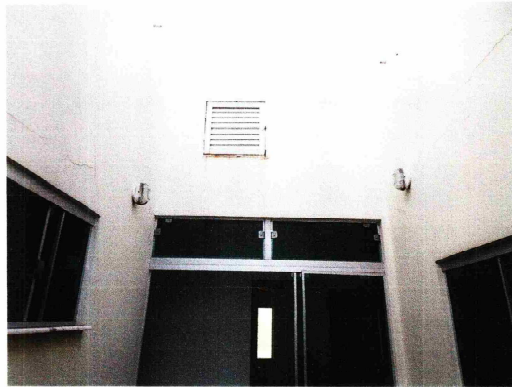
VISTA INTERNA POÇO DE ILUMINAÇÃO
